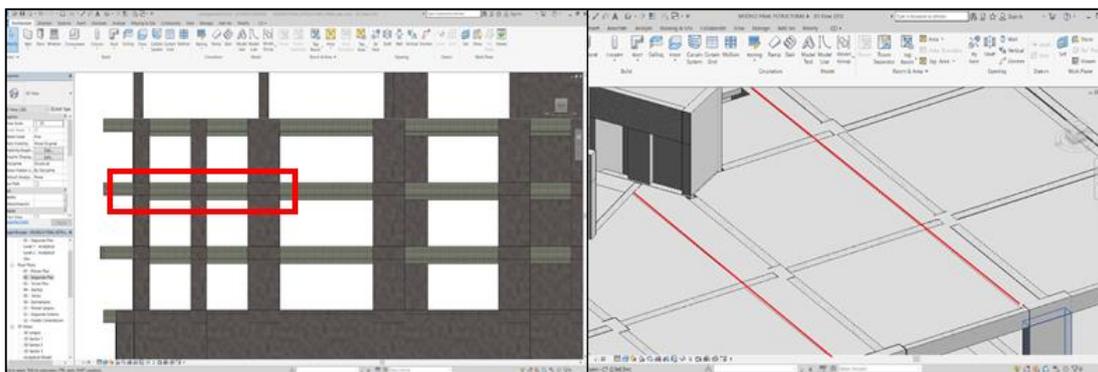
Modelado de cimentación, subestructuras y superestructura en Revit 2018.
